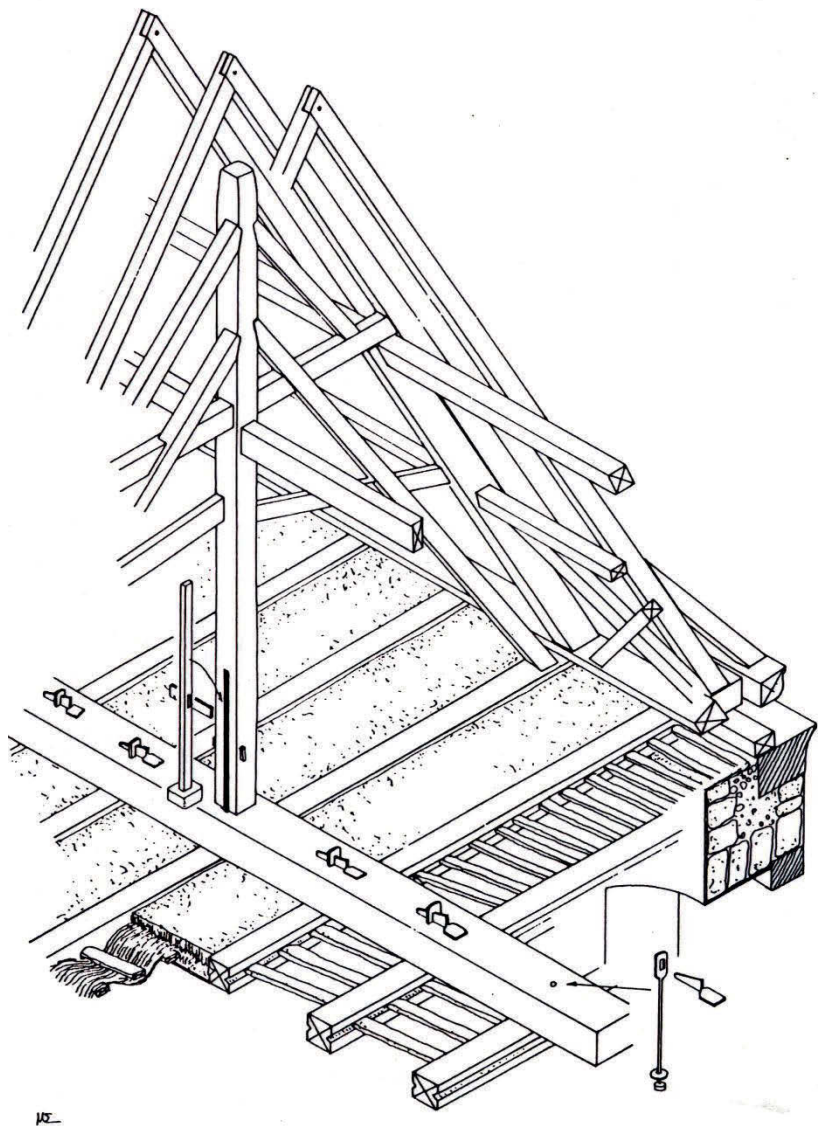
Dachkonstruktion mit Hängewerk über dem Rittersaal, 1604
